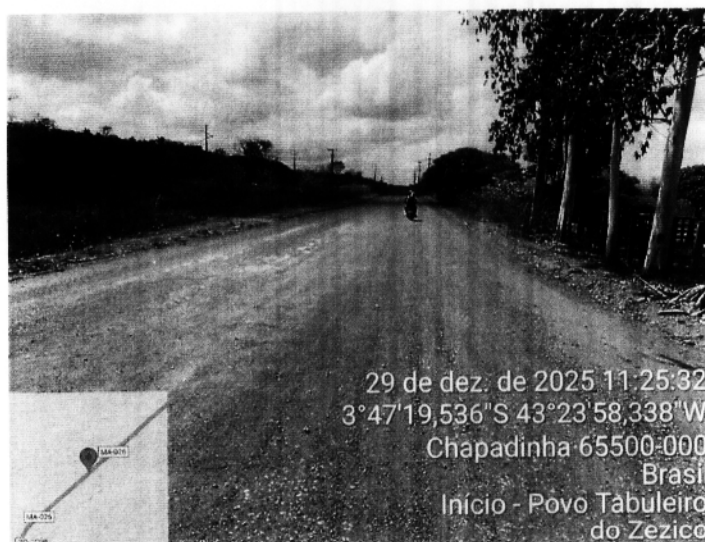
INÍCIO DO TRECHO – KM 0.00 – POVOADO TABULEIRO DO ZEZICO
